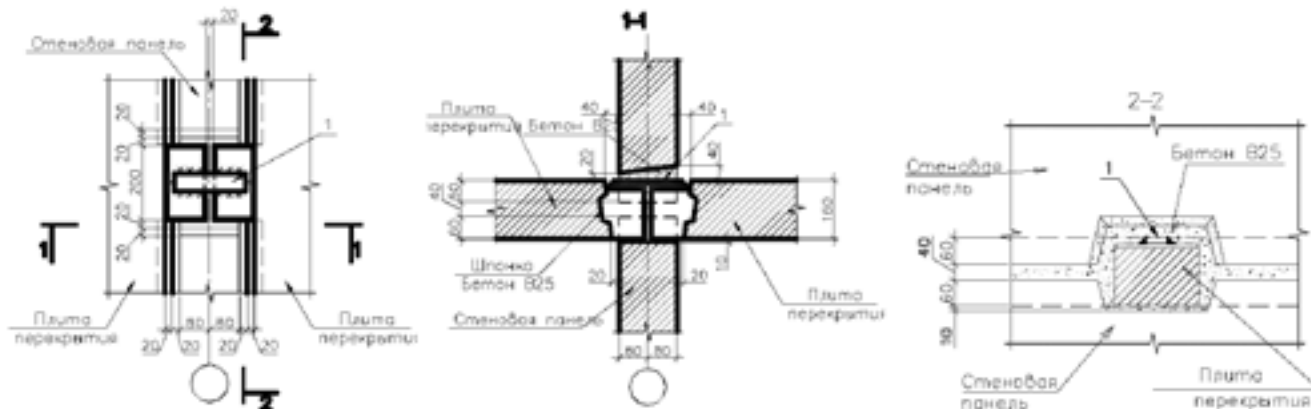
Горизонтальный стык шпоночного сопряжения плит перекрытий и стен
